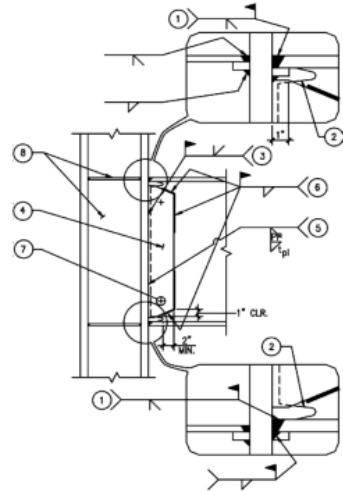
Aleta soldada sin refuerzo - alma soldada.
